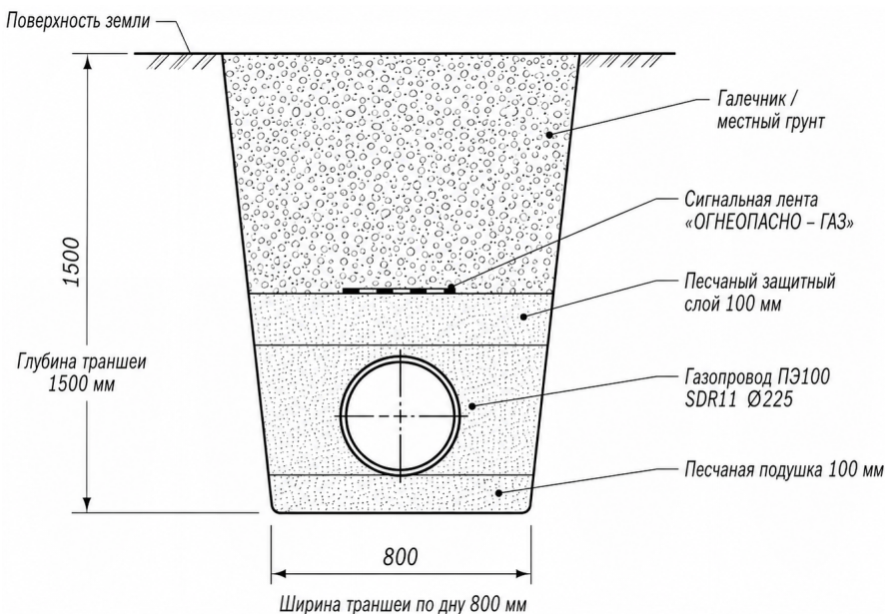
Поперечное сечение траншеи при замене газопровода.
